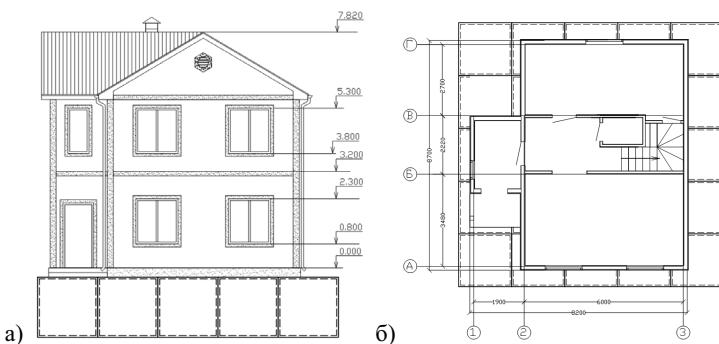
Проект двухэтажного жилого дома на воде: а) фасад в осях «1» - «2»; б) план первого этажа.
